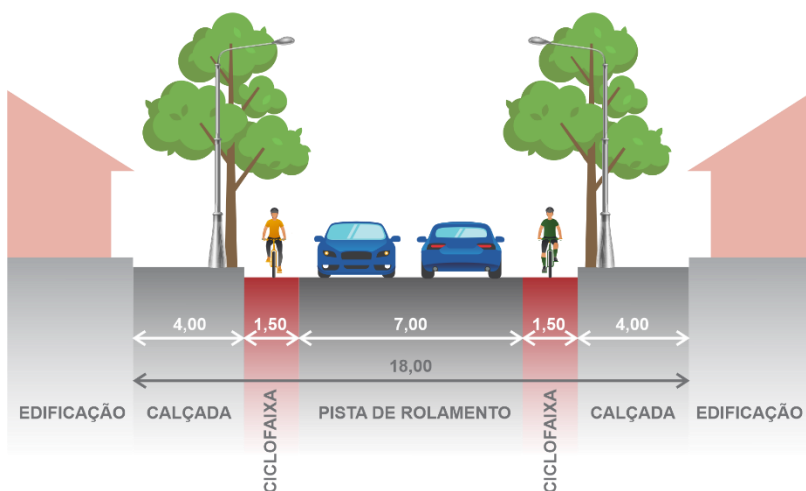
Via Arterial Tipo 1: estrutura e dimensões
